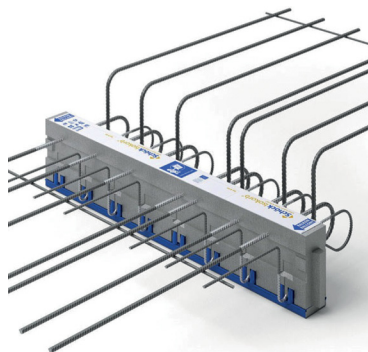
Exemplo de uma solução de corte térmico para ligação entre lajes e varandas exteriores (fonte: Schöck Isokorb), já aplicadas entre nós, permitindo, em hotéis, que a varanda de cada quarto esteja isolada do pavimento.
